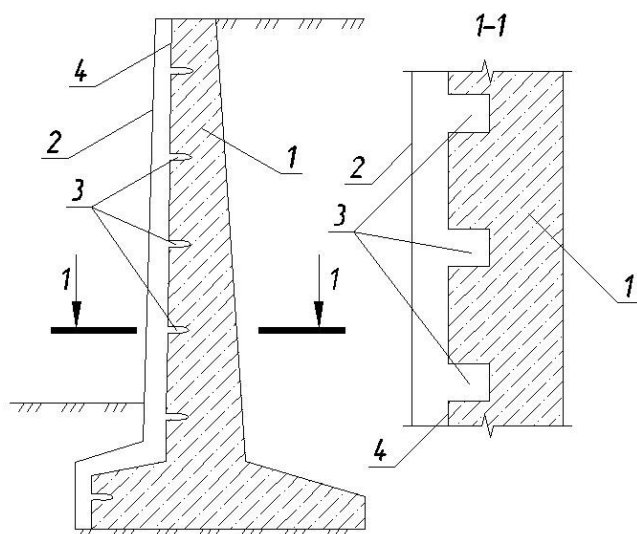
Улаштування бетонного нарощування в стиснутій зоні: 1 – бетонна або залізобетонна підпірна стінка; 2 – бетонне нарощування в стиснутій зоні; 3 – ніші, влаштовані в підпірній стінці; 4 – підготовлена до бетонування поверхня
